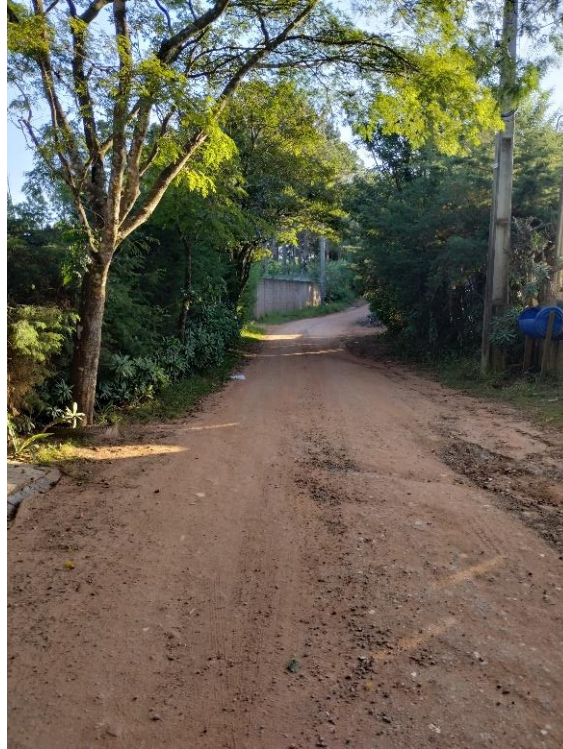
VISTA DA RUA DOS CRAVOS
